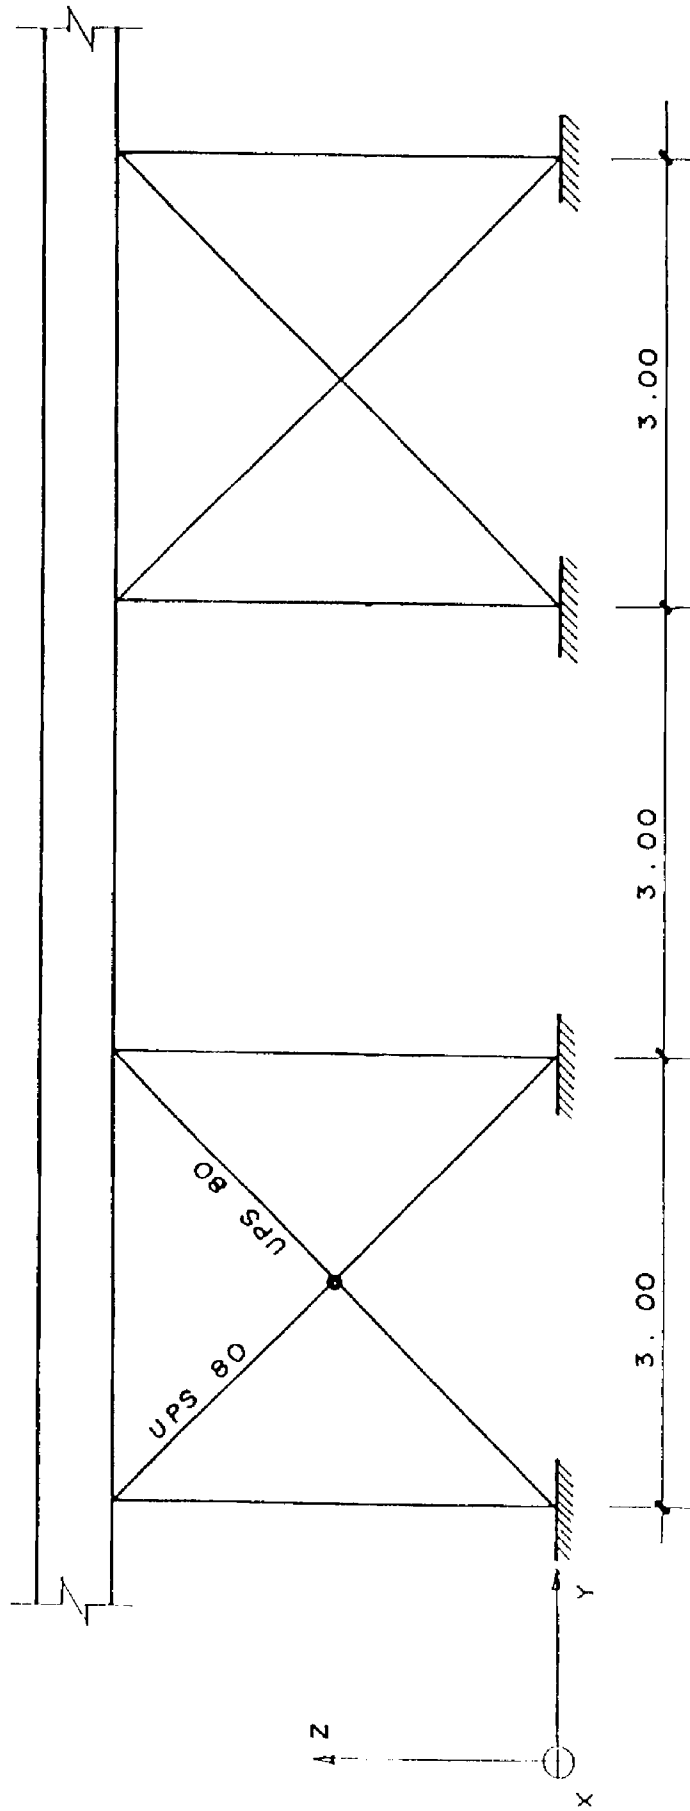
REFUERZO EN EL PLANO YZ
